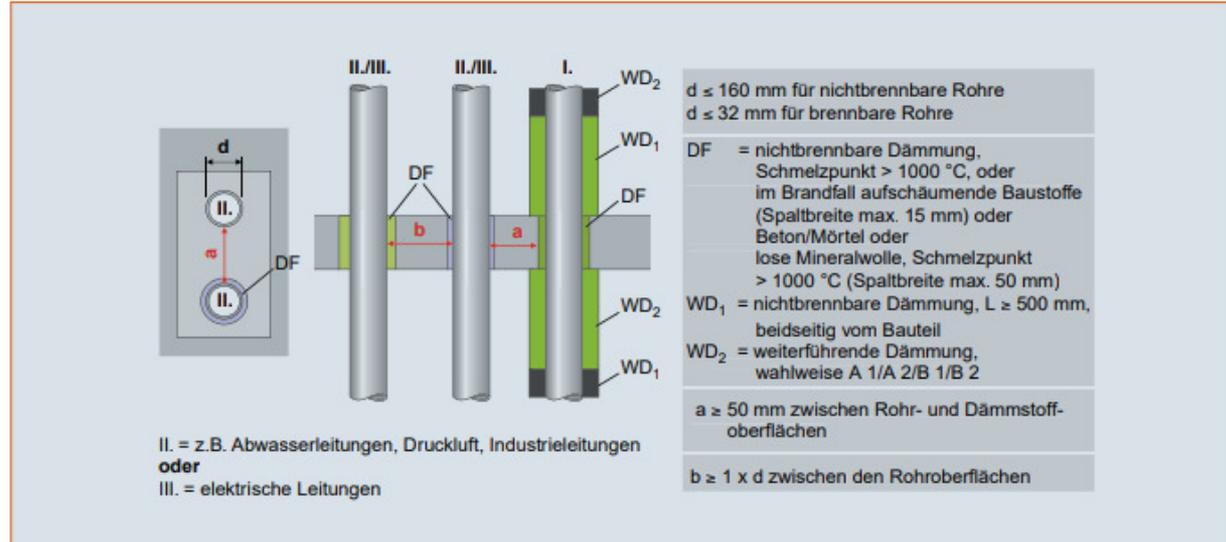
Durchführung von ungedämmten Leitungen gemäß Abschnitt 4.3 MLAR
